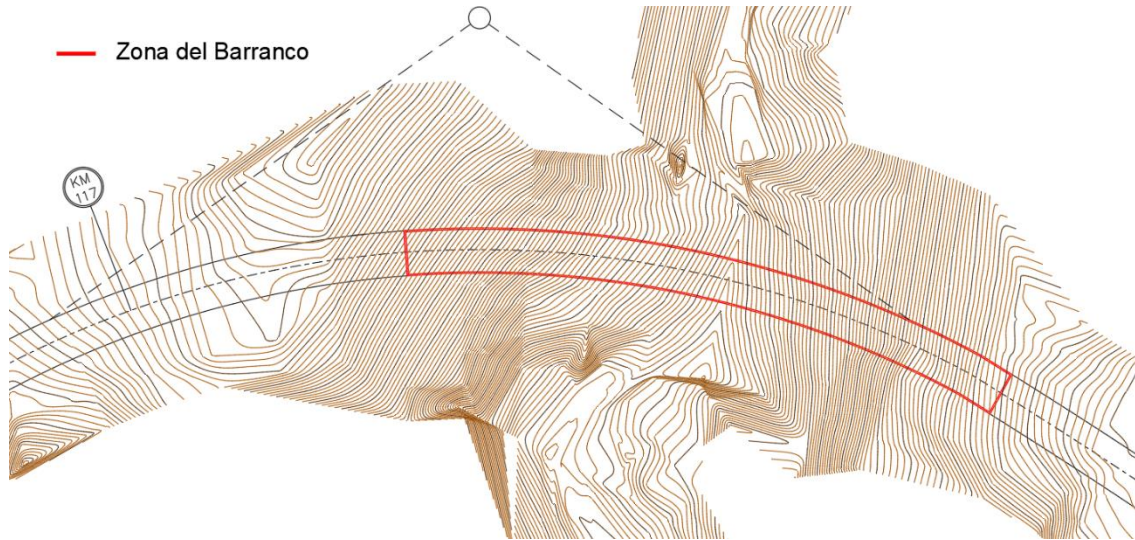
Planta topográfica del sitio. Fuente: Elaboración propia
